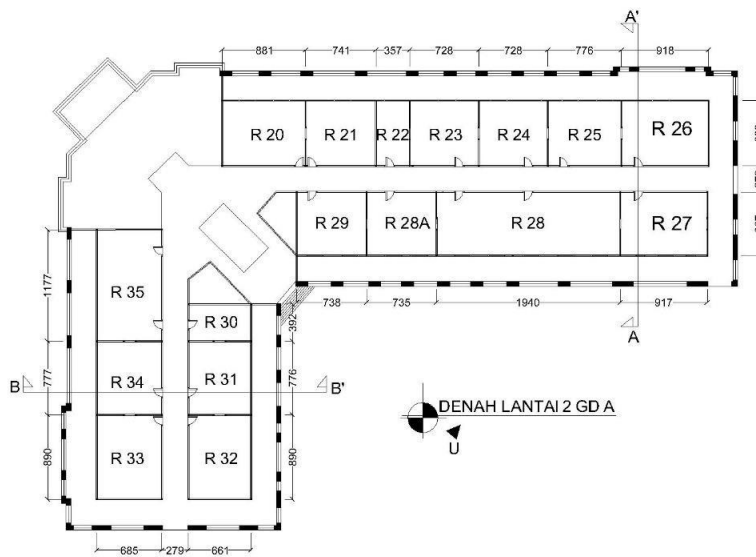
Siteplan Lawang Sewu Semarang Sumber: (Setyowati 2013)
